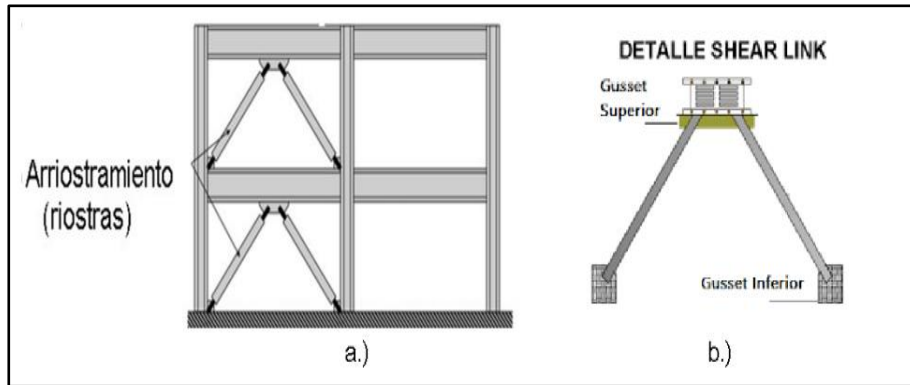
Pórtico arriostrado concéntrico. b.) Detalle de uso de placas gusset. (Gonzales, 2017)
